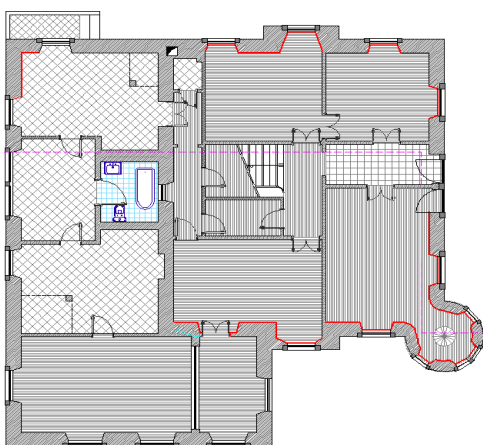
Localização em planta das eflorescências no reboco interior das fachadas na planta do rés-do-chão.
